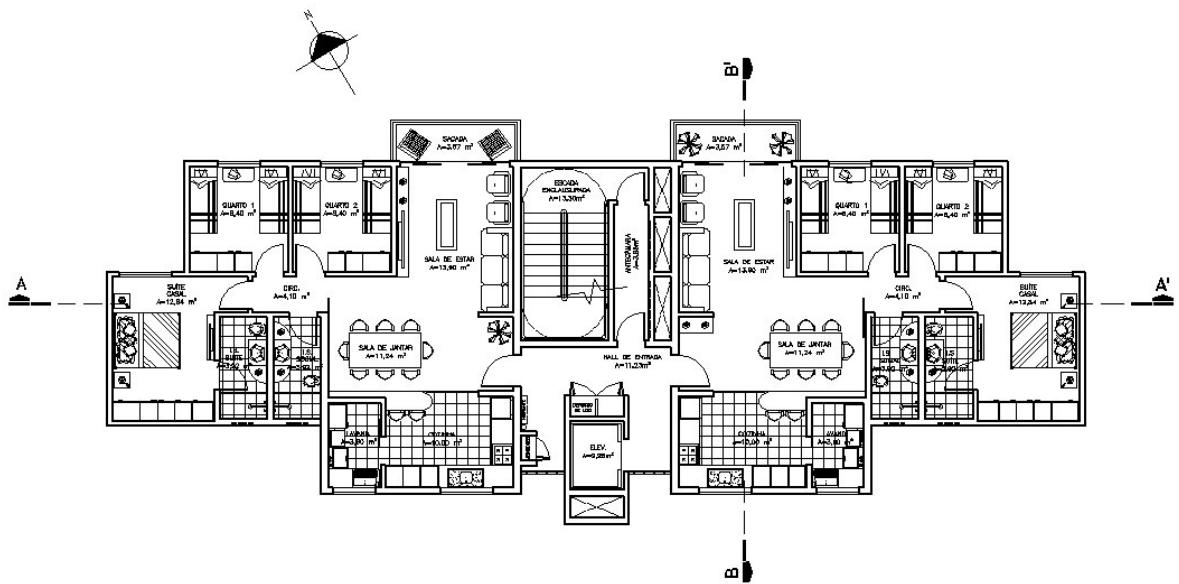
Planta do Pavimento Tipo do objeto de estudo global
